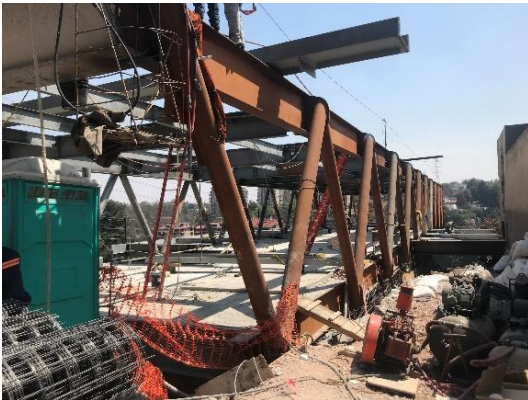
Vista lateral lado sur de la techumbre sobre la losa de concreto
